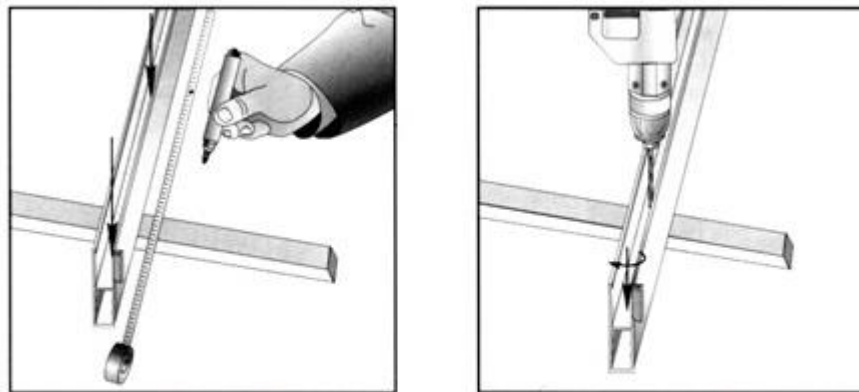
Разметка и сверление отверстий в направляющих при встроенном монтаже.
